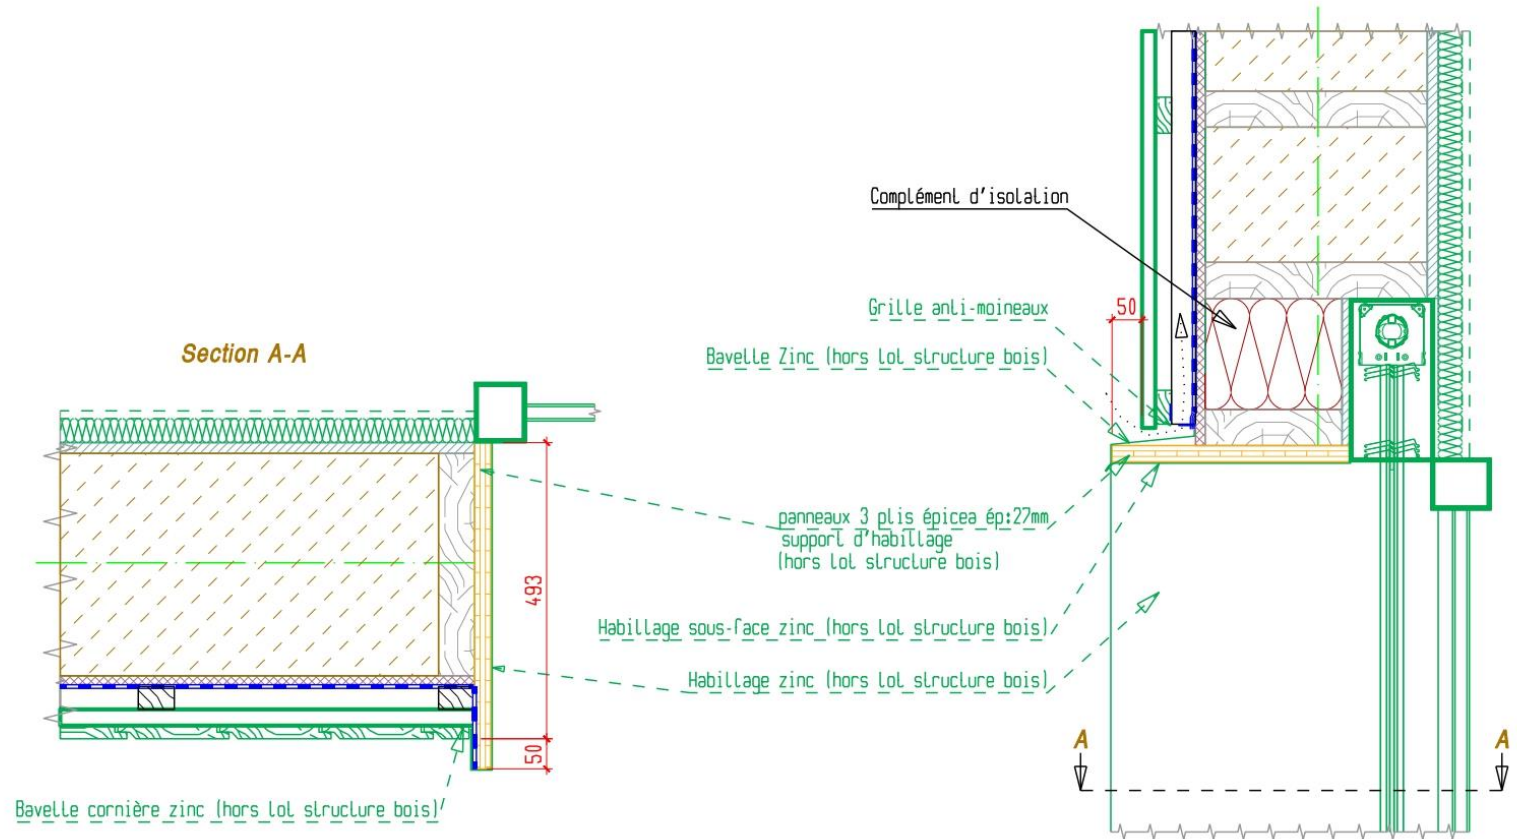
DETAILS BUREAU D'ETUDE STRUCTURE BOIS
